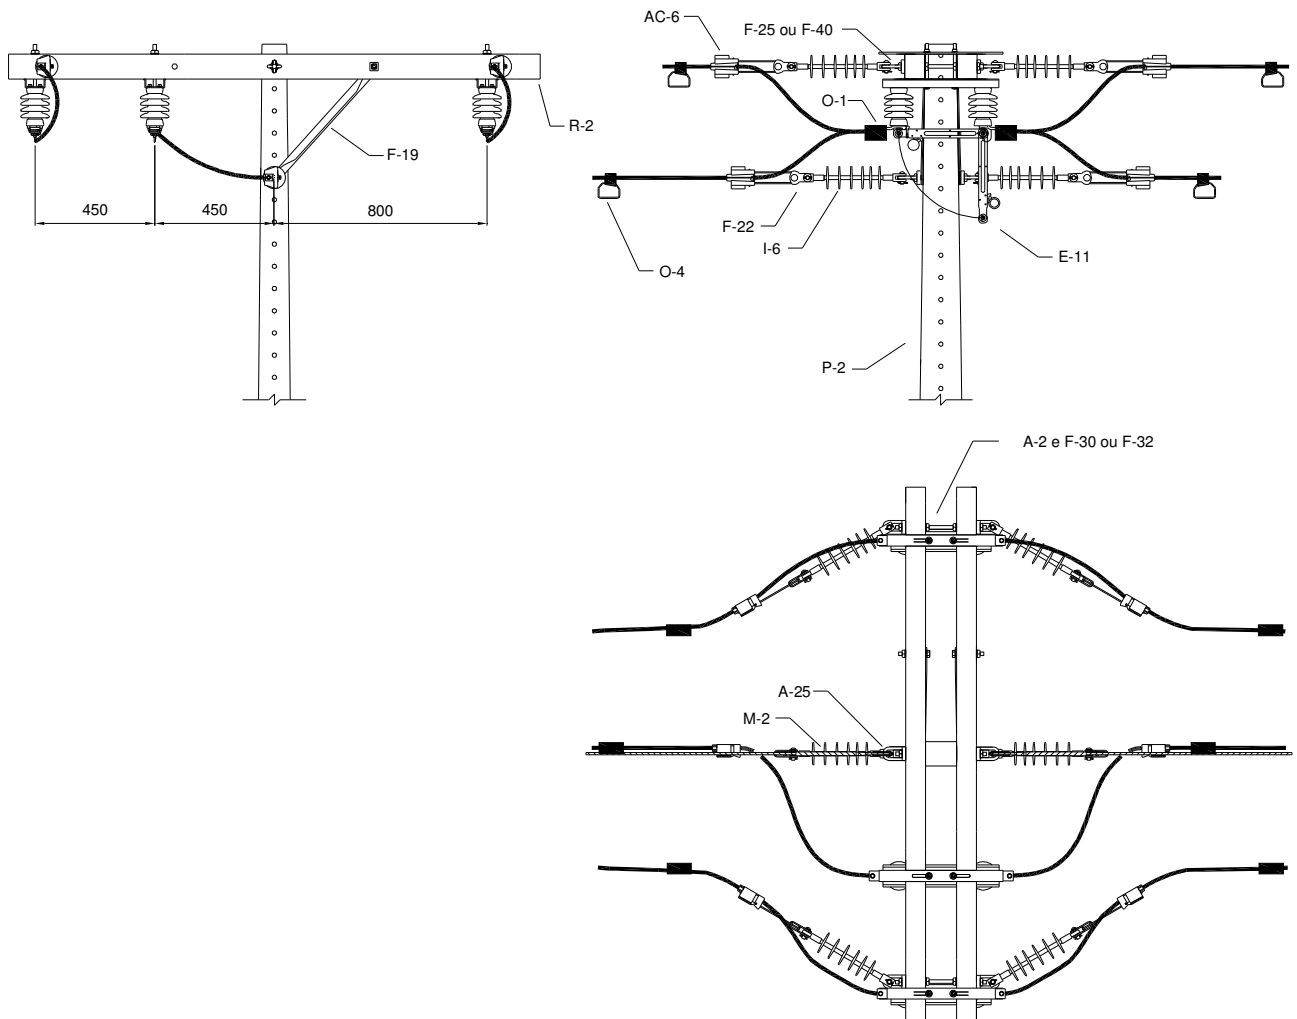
Estrutura CE4 SU – Poste de Concreto de seção duplo T
